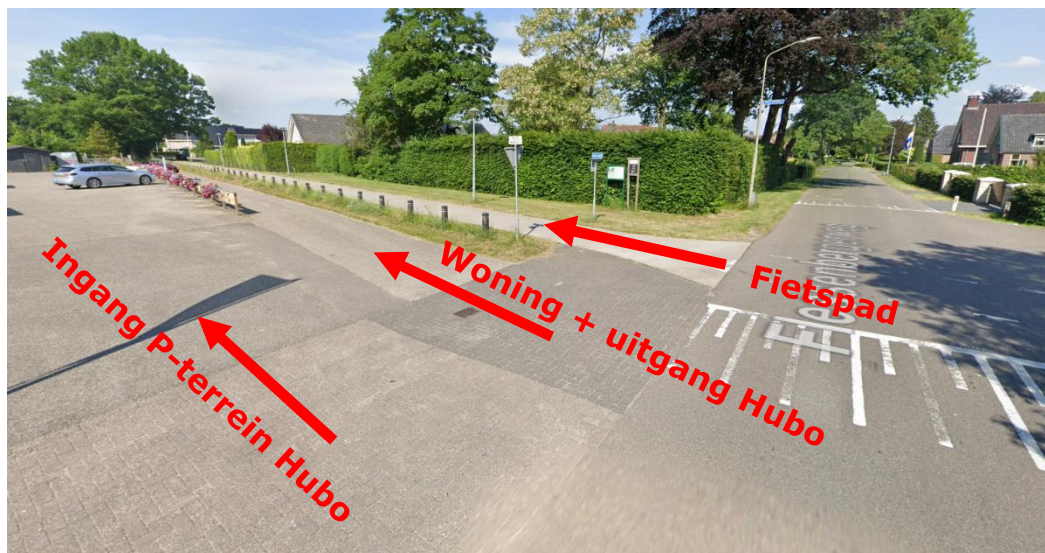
Ligging plangebied en ontsluitingsstructuur
